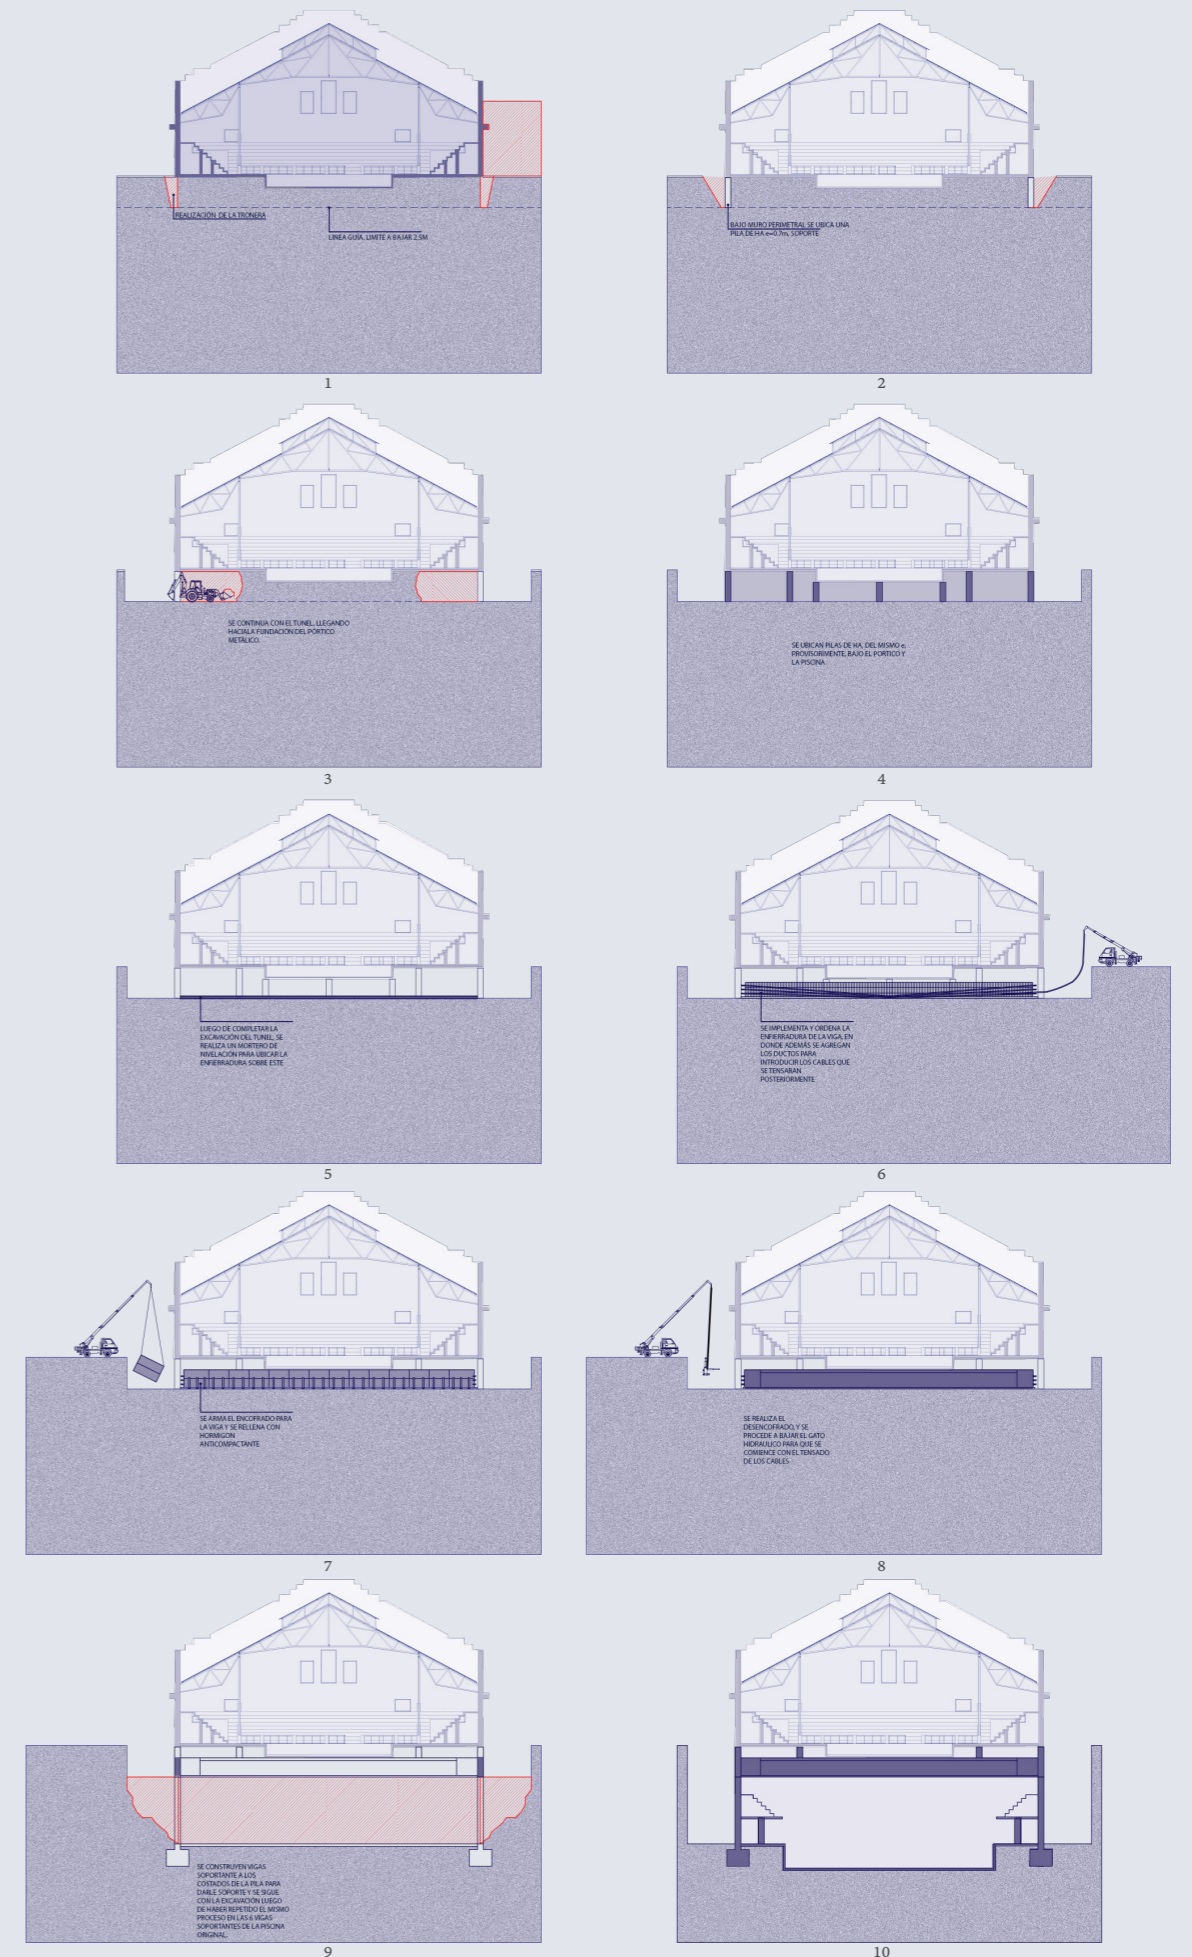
Diagramas constructivos. Fuente: Elaboración propia
